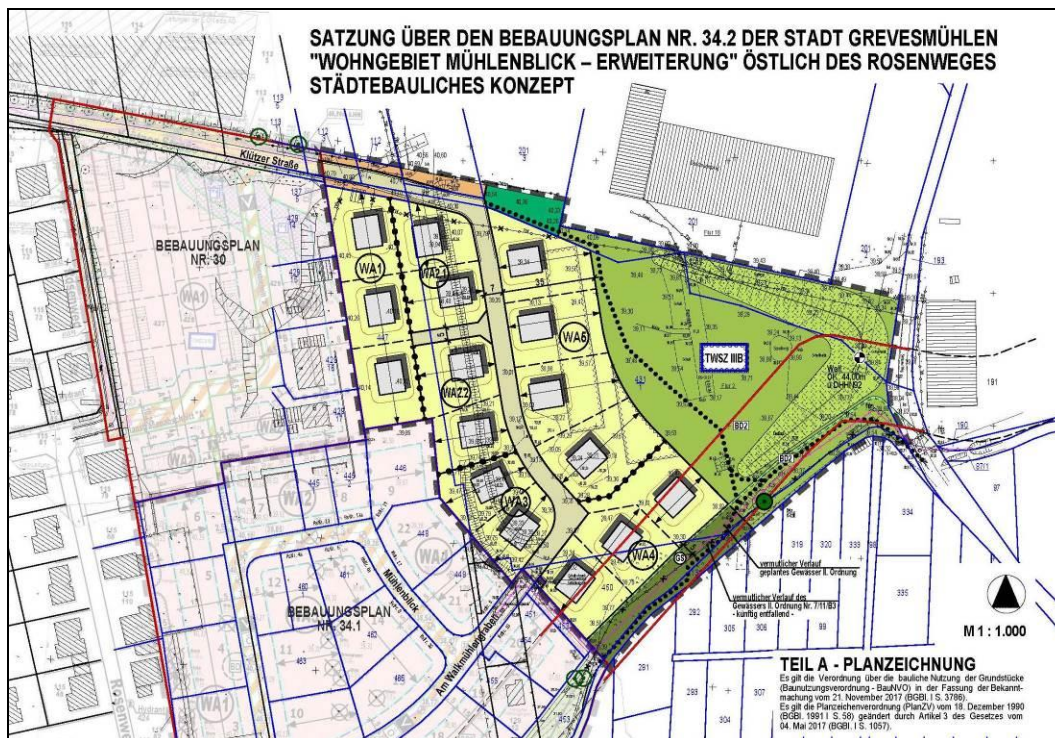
Planungsbereich mit der Planungsabsicht (Quelle: Planungsbüro Mahnel)
